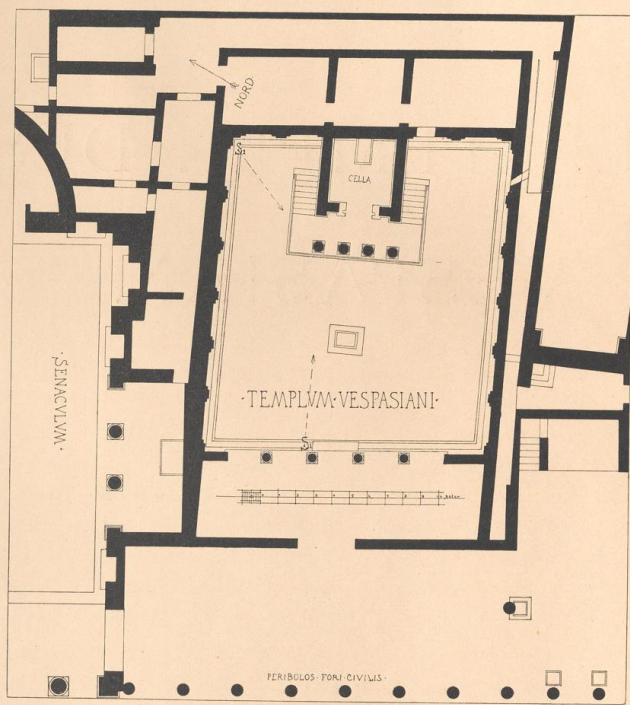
Grundriss zum Tempel des Vespasian.
